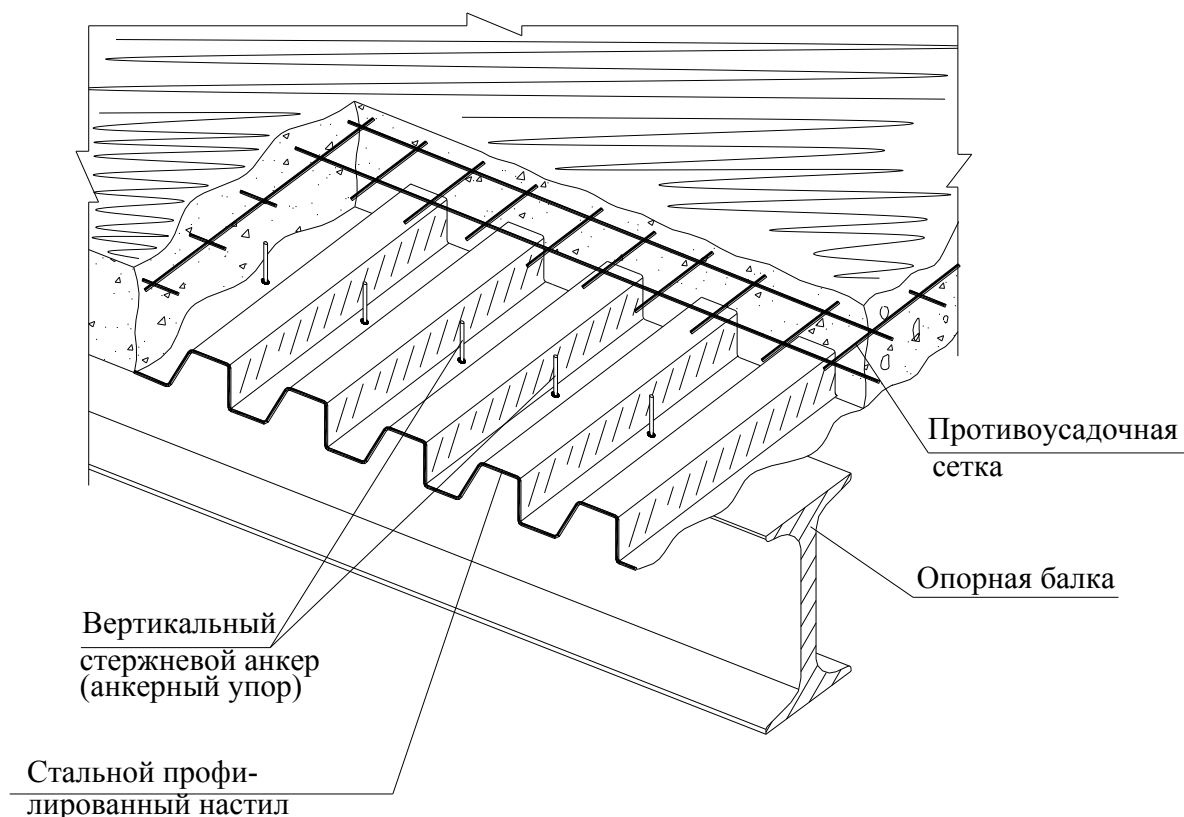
Конструкция перекрытия с опиранием на стальные опорные балки (вариант)
